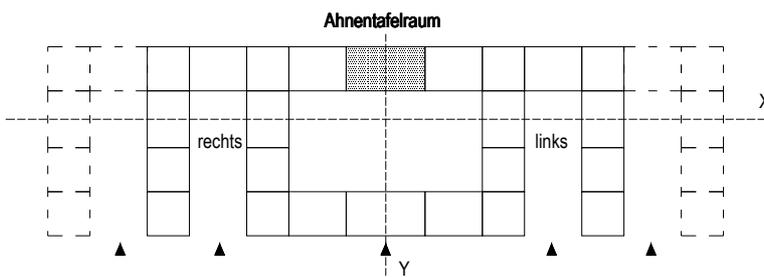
Grundriss-Schema des horizontal erweiterten Wohnhofs
